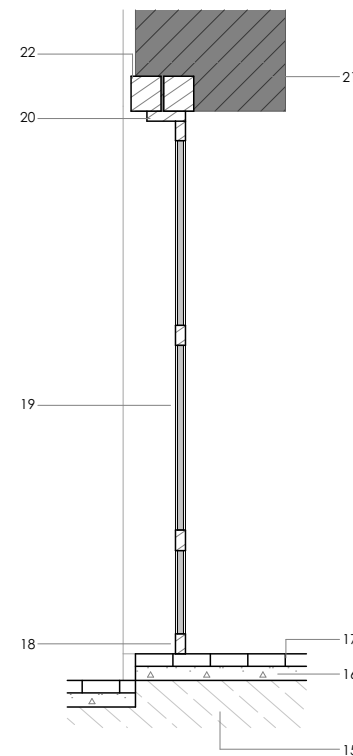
Detalle Constructivo 03. ESC 1:50
